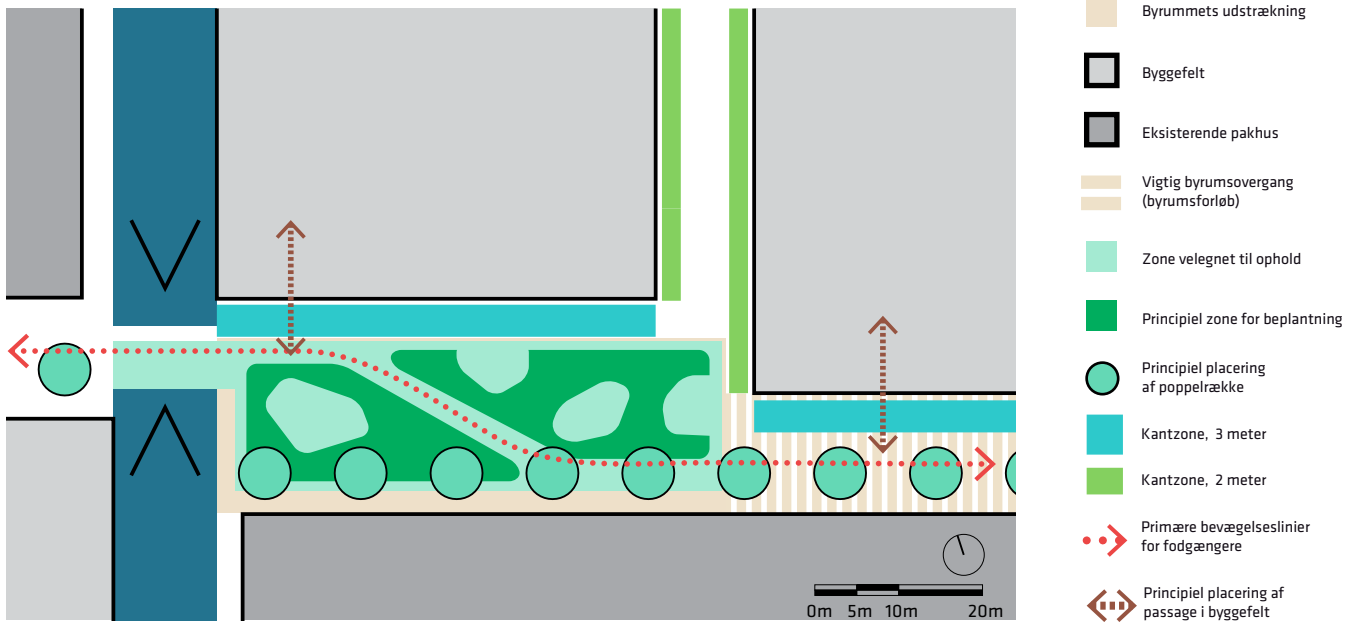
Plandiagram: 'Kanalhaven'
